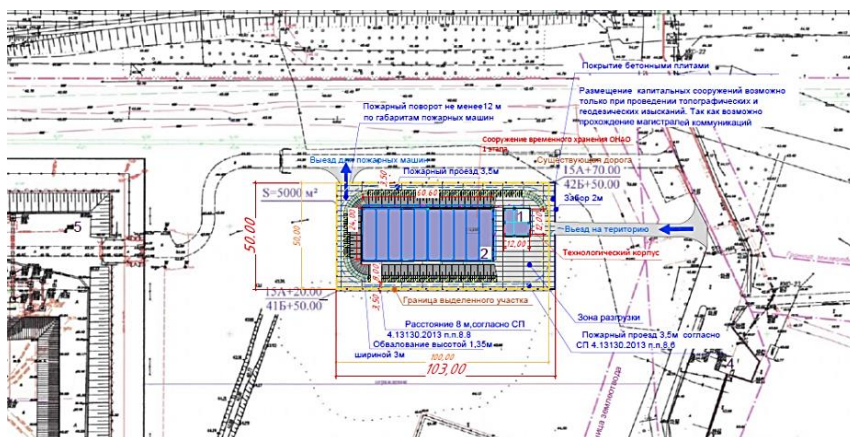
План размещения ПЗ ОНАО [Disposal site plan for very low level waste]
